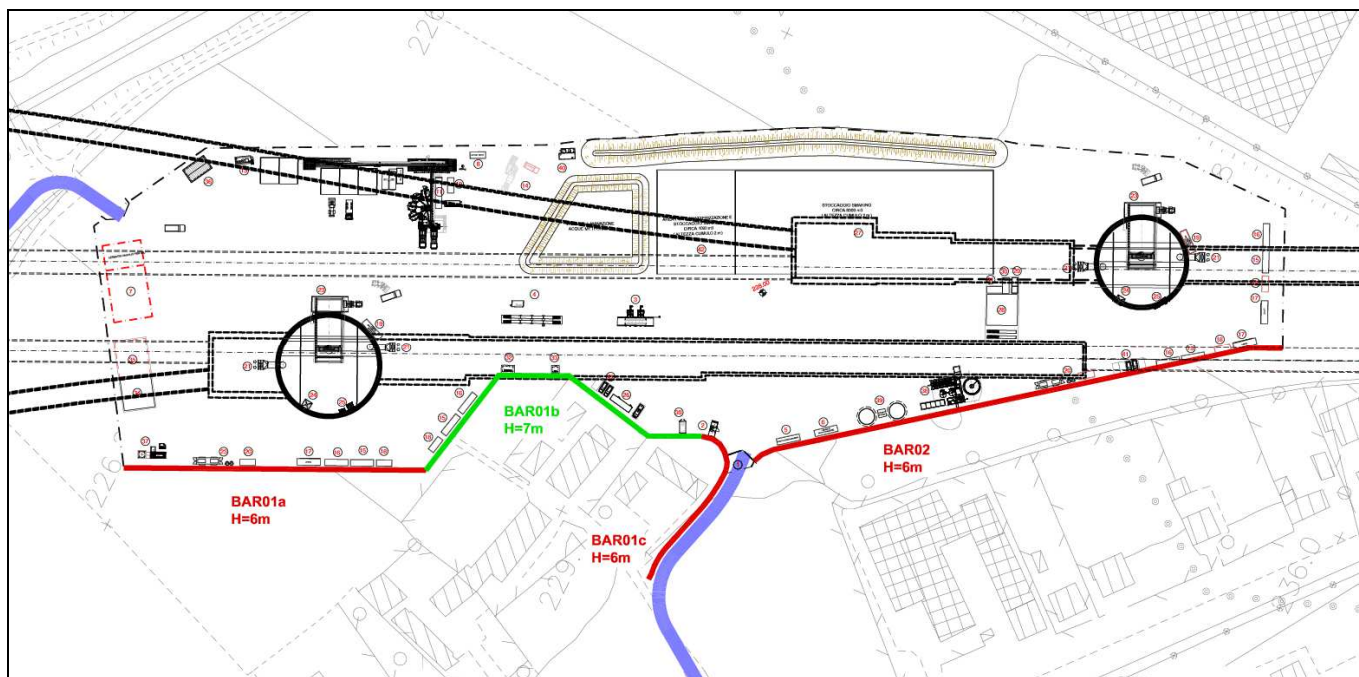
Layout Area di cantiere con indicazione della Barriera acustica
